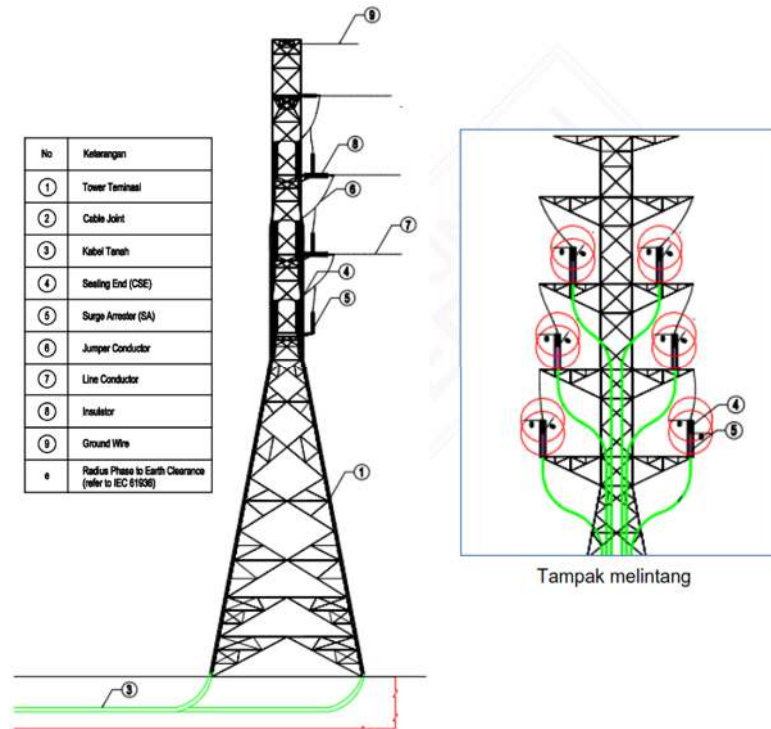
Contoh gambar struktur penyangga terminasi di AIS
